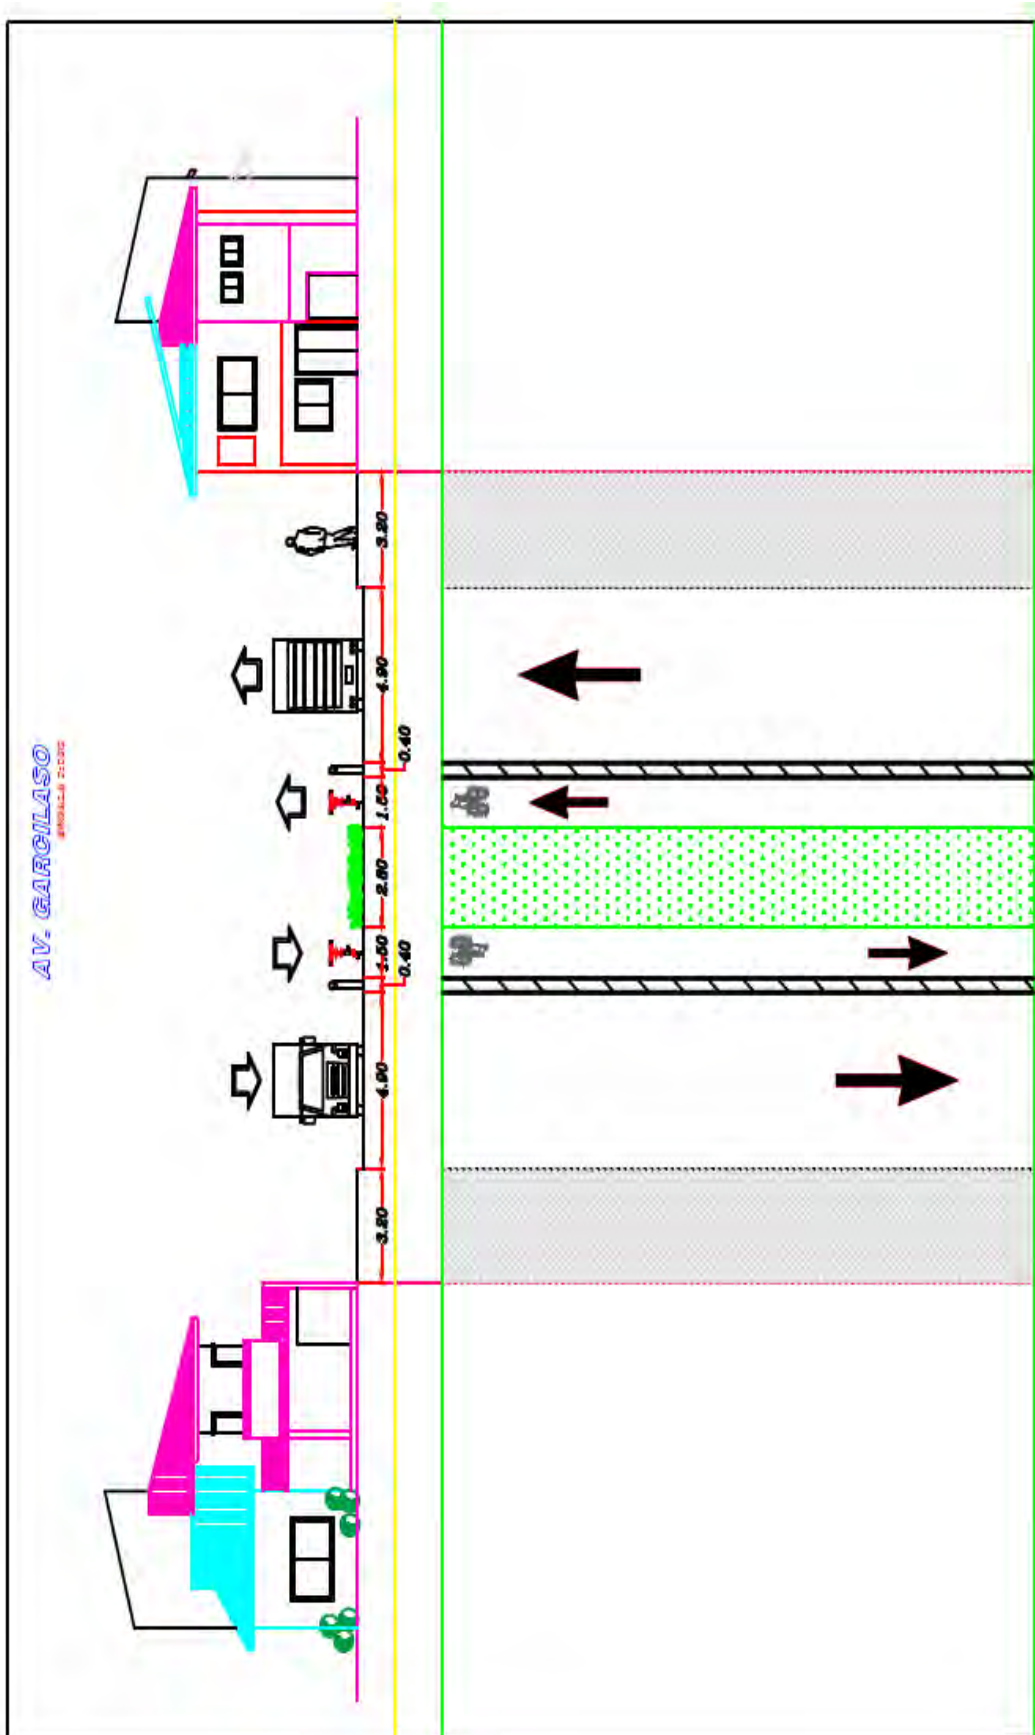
Propuesta Sección Transversal Av. Garcilaso.
